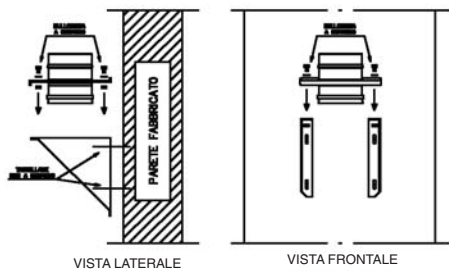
A *Installazione coppia angolare con piastra intermedia
